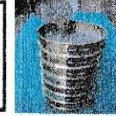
COLUMNA C-1, UBICADO EN EL 1ER. PISO EJE 3-3/C-C, SE UBICA A LA PUERTA DE LA COCINA CON EL TRAGALUZ
